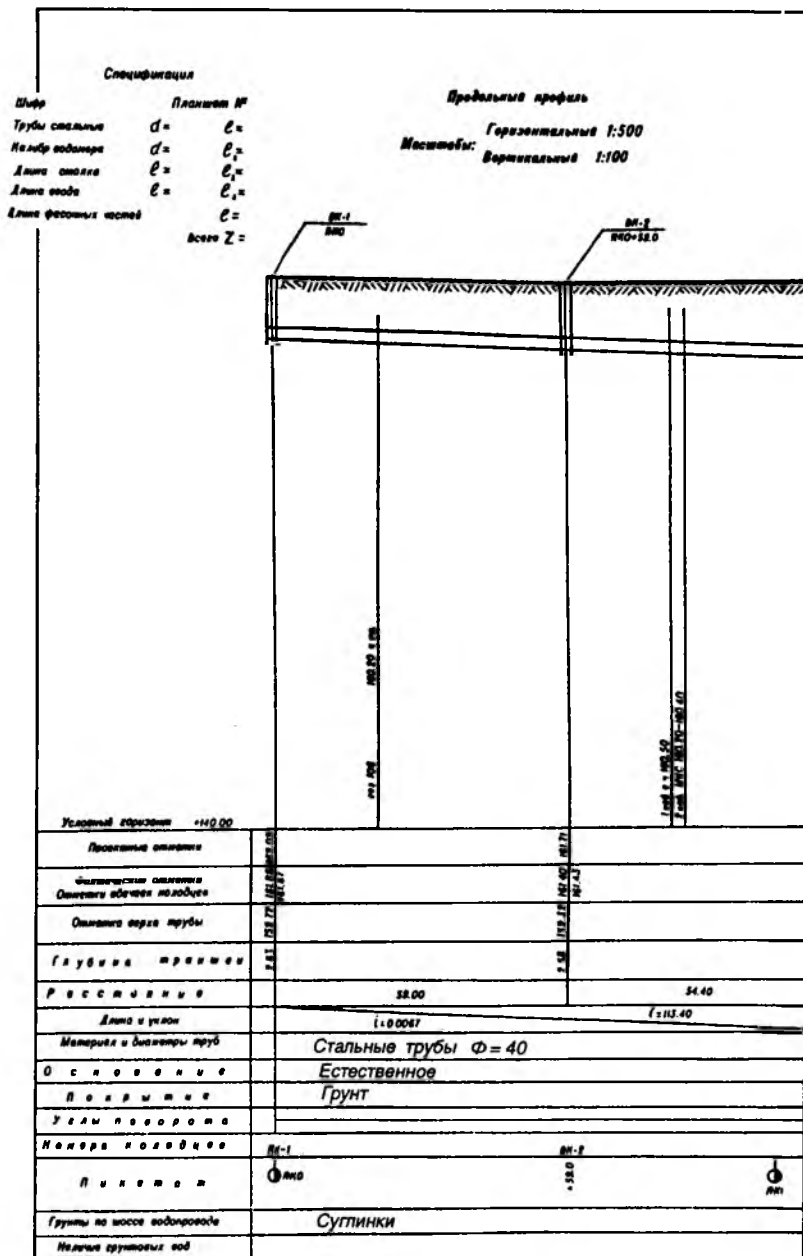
Образец оформления исполнительного чертежа (профиль)
